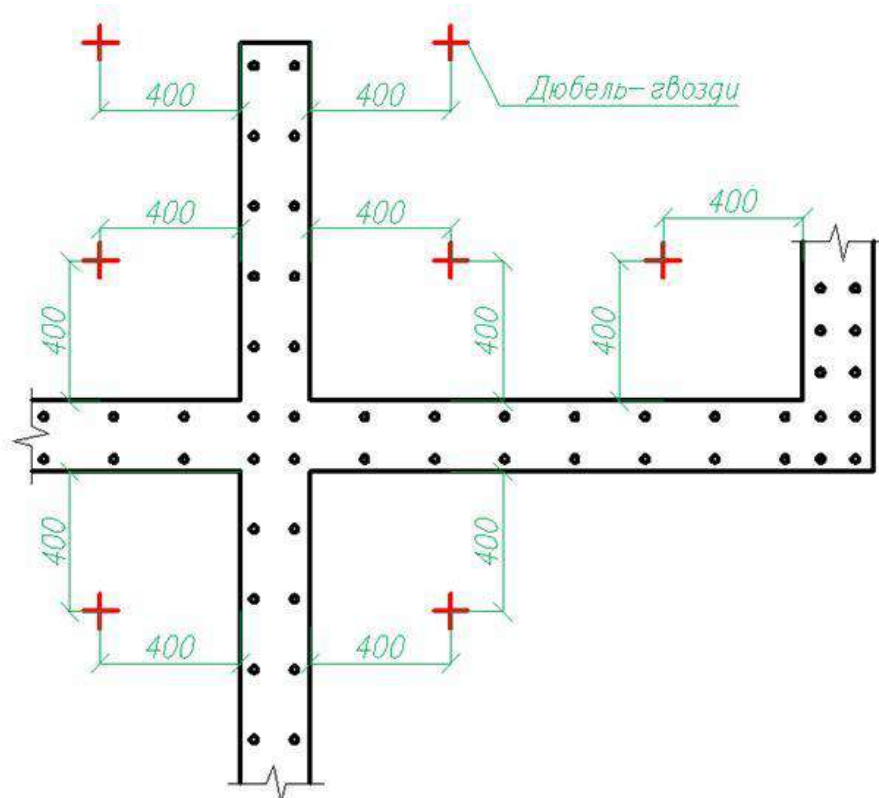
Забивка дюбель-гвоздей перед монтажом стен
